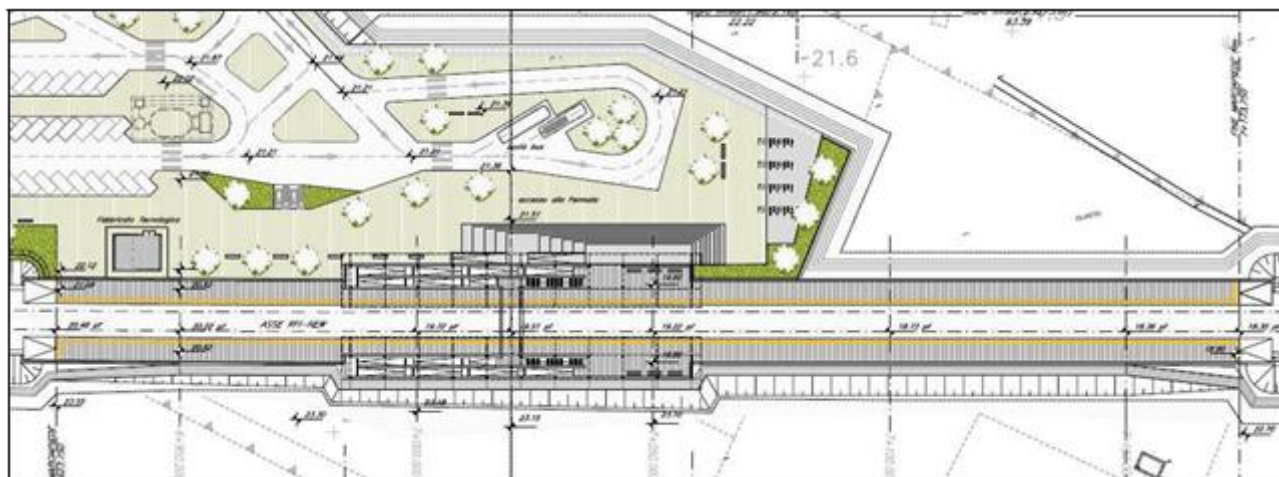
Fig. 5 – Planimetria fermata Triggiano
